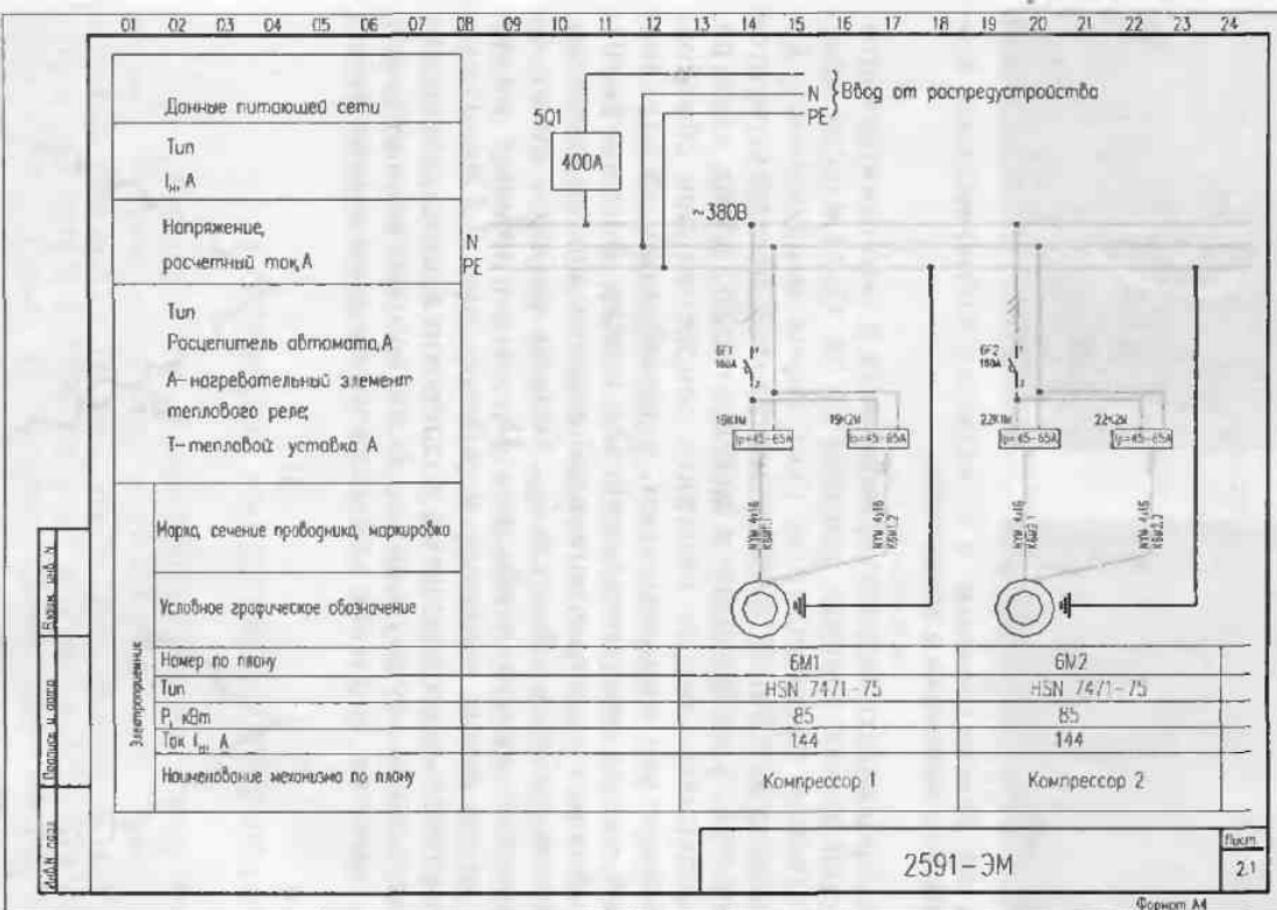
Пример принципиальной однолинейной схемы электроподключения трехфазного двигателя полугерметичного винтового компрессора
